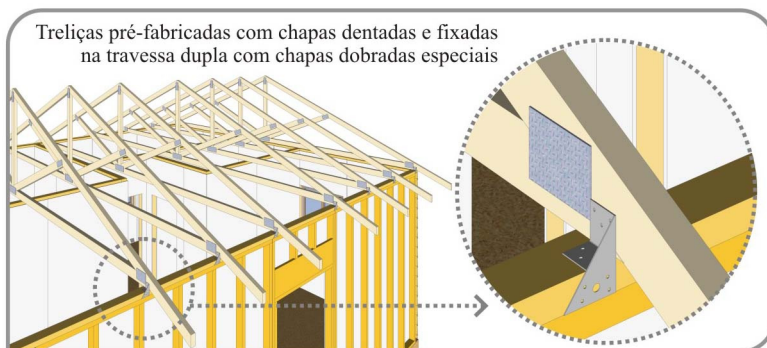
Fixação reforçada da treliça sobre as travessas duplas
